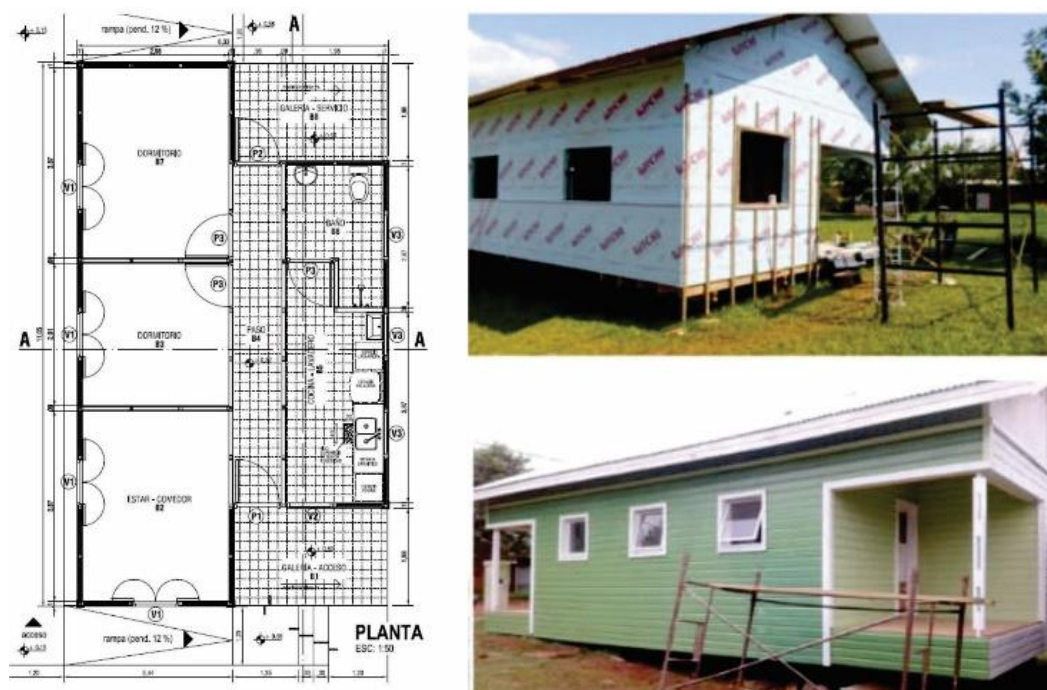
Planta, proceso constructivo y vivienda terminada del caso 1.
